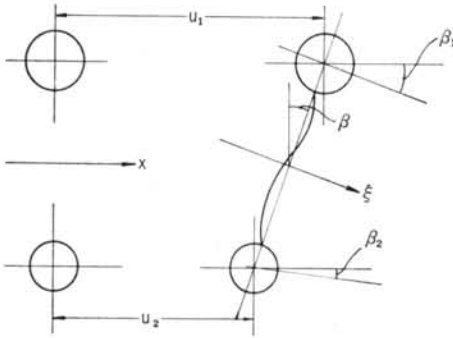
TRUSS 弦材の横座屈変形⁴⁾⁵⁾⁹⁾¹⁰⁾¹⁴⁾¹⁶⁾
